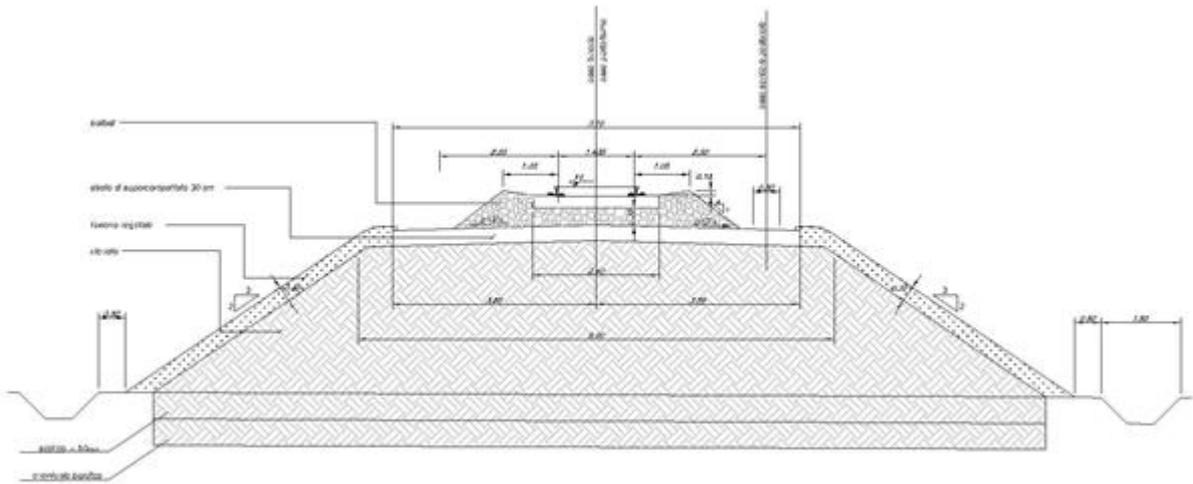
a – Sezione tipo rilevato deviata provvisoria
